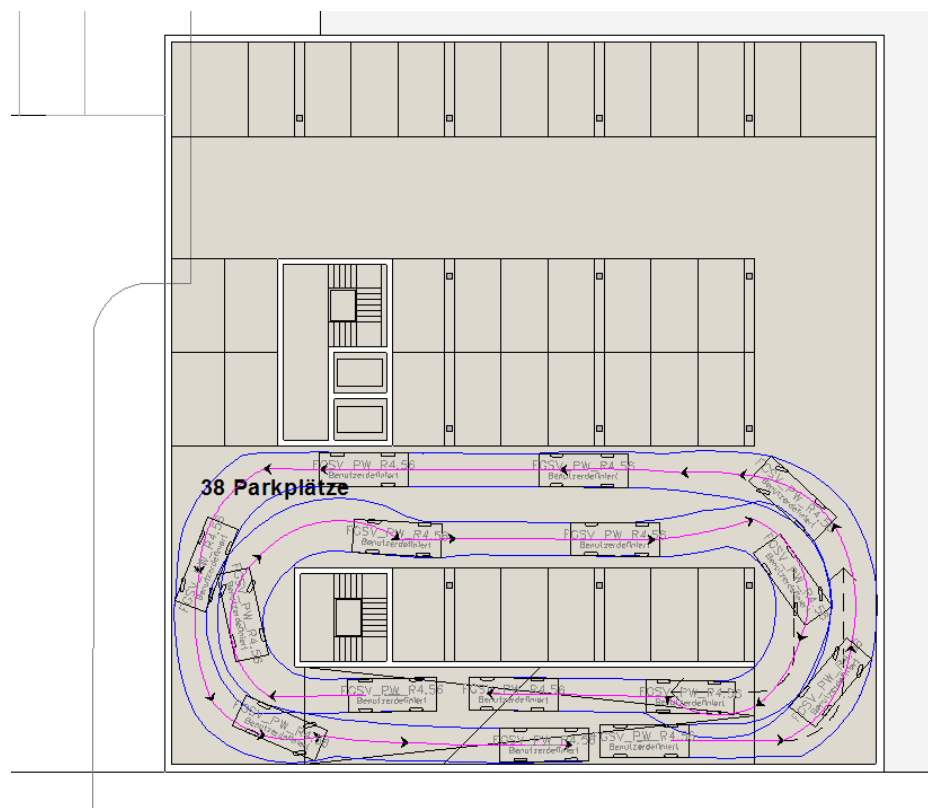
Fahrgeometrie Erschliessung Parkierung Baufeld C
